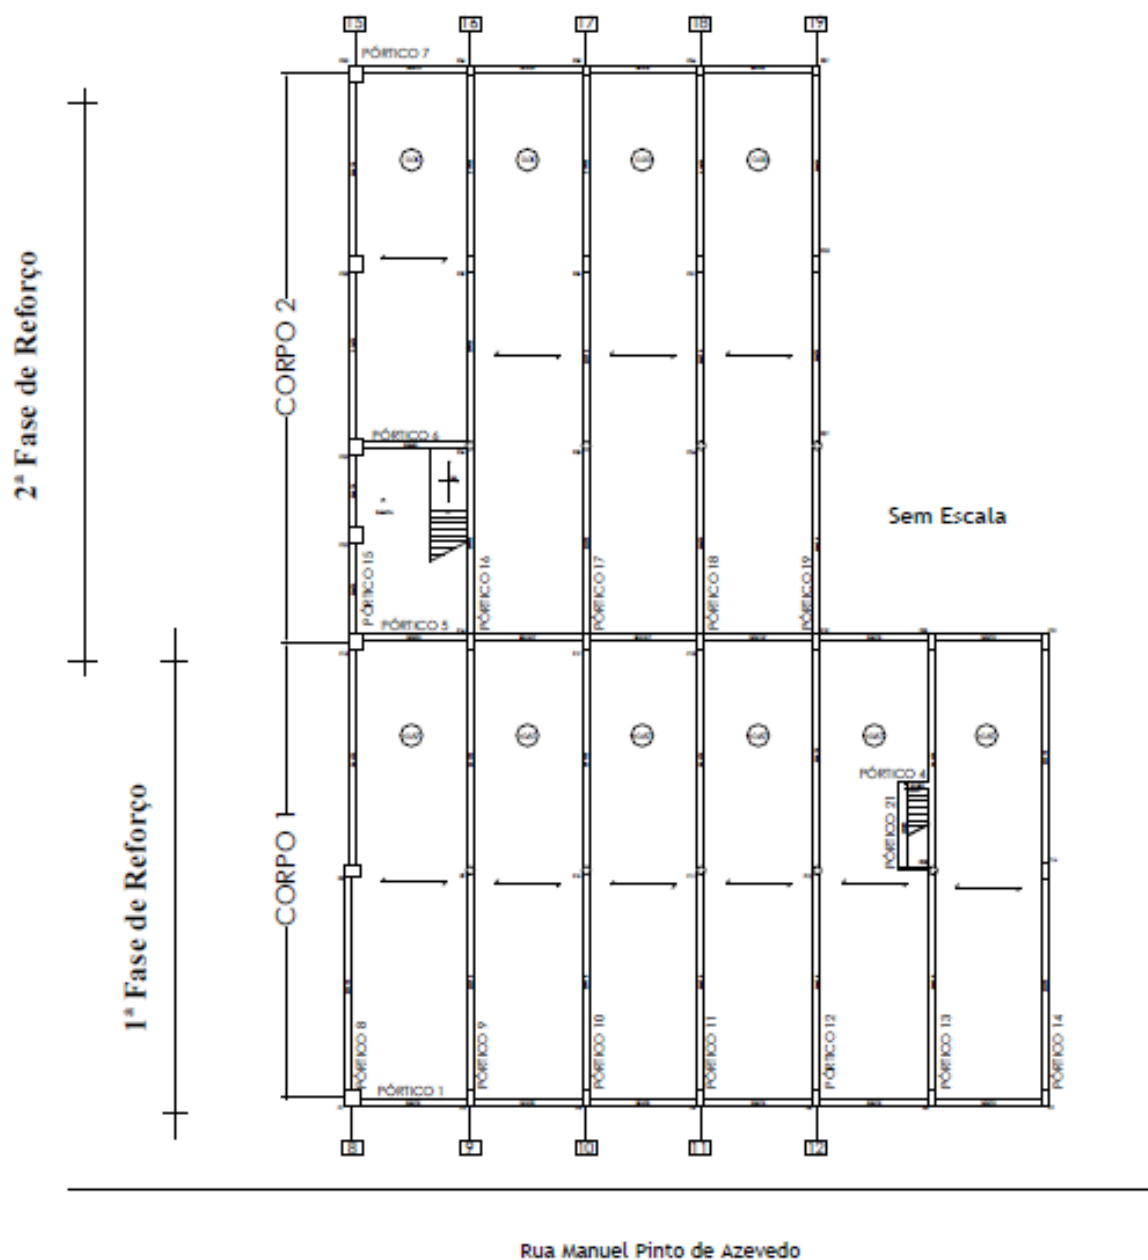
Planta estrutural do edifício (Azevedo, 2008)
